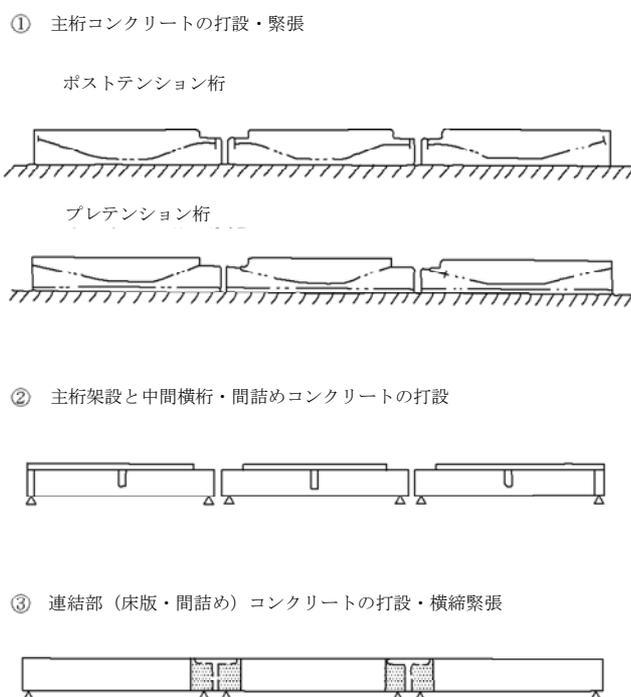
プレキャスト桁架設方式連続桁橋の一般的な施工手順
